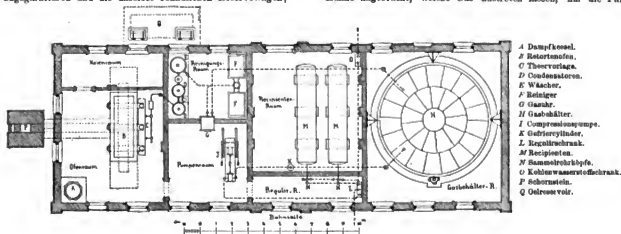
Oelgasanlage, — Grundriss.
